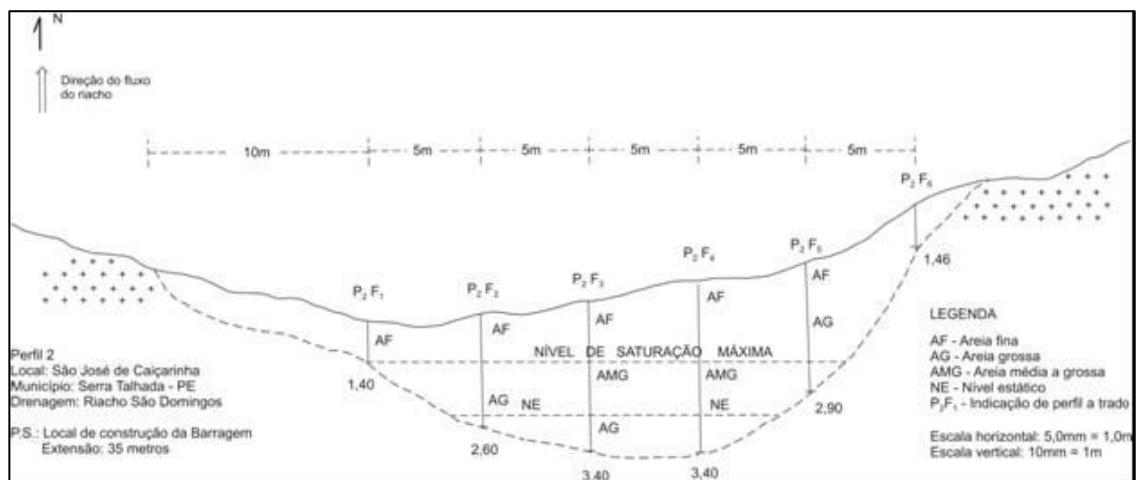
Seção transversal evidenciando a composição arenosa e a espessura do pacote aluvial no local da construção barragem subterrânea Z-W-01
